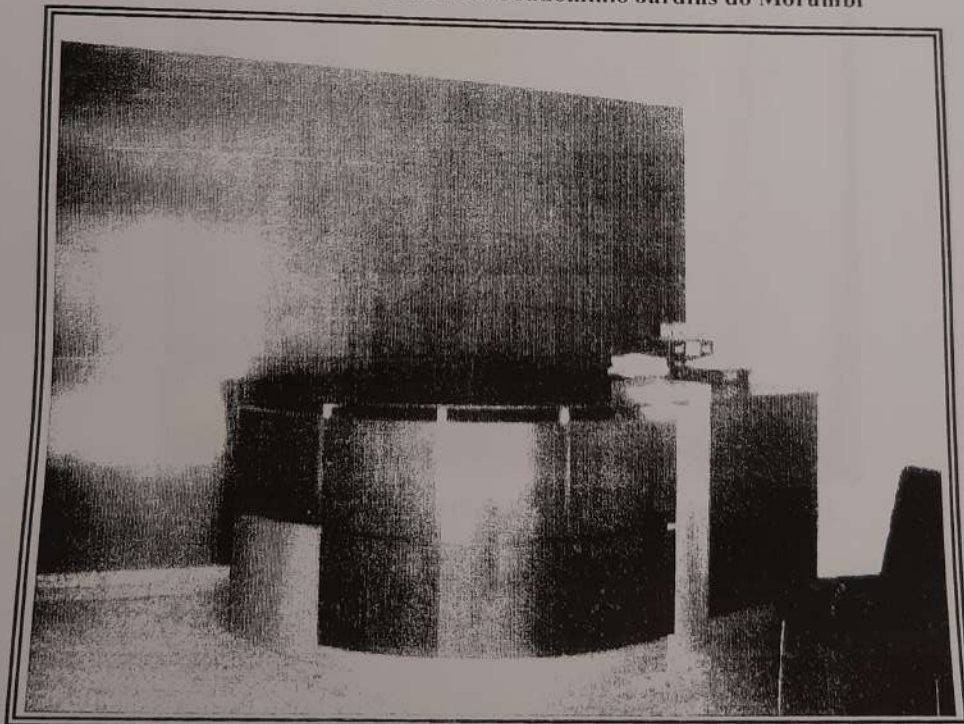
Vista do hall de entrada do Condomínio Jardins do Morumbi
